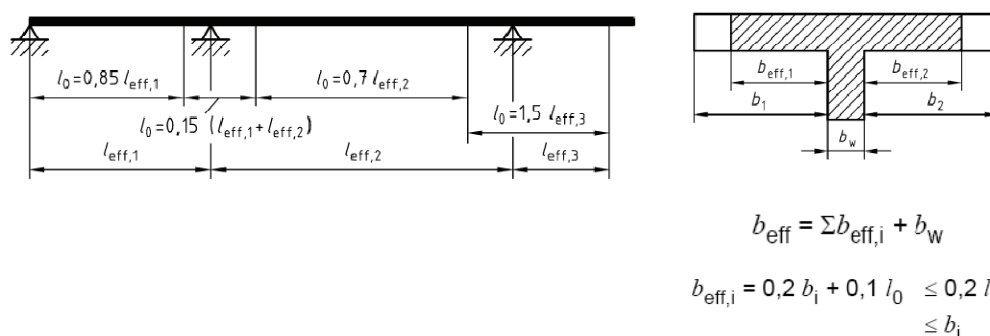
Mittragende Breite für Plattenbalken aus Beton [DIN 1045-1]
